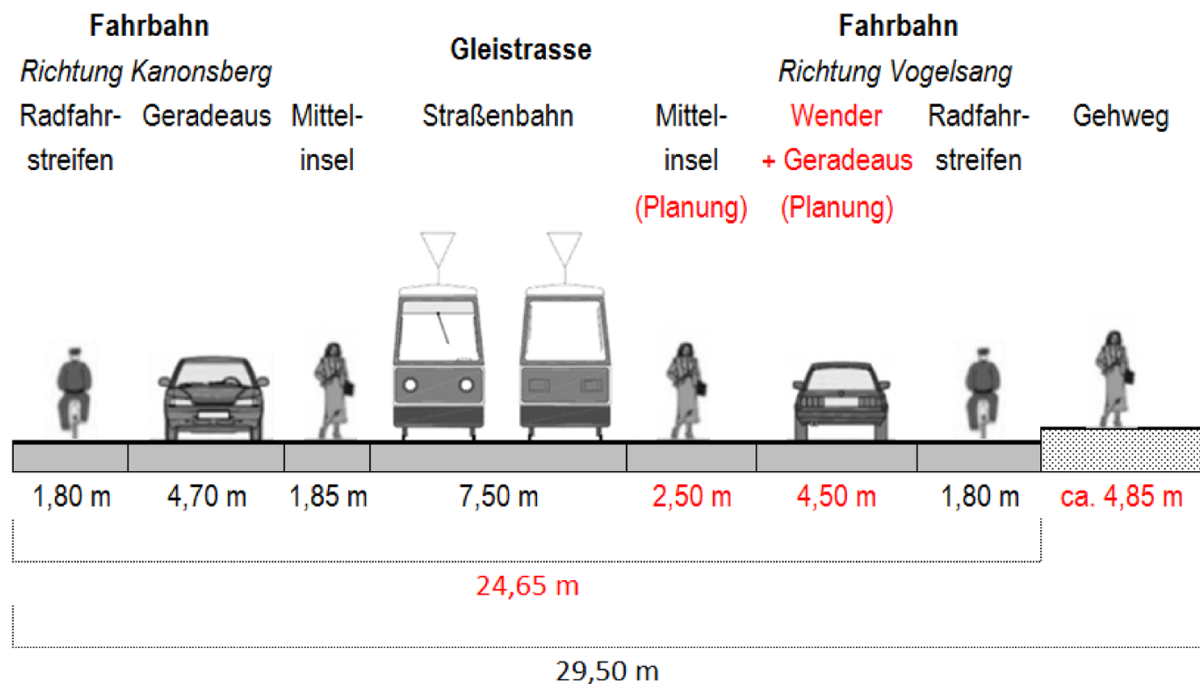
Geplanter Straßenquerschnitt am Knotenpunkt Lange Straße/Vogelsang
